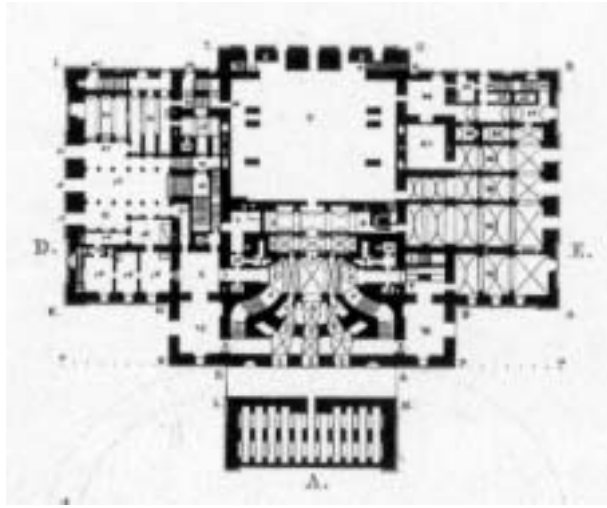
Erdgeschossgrundriss des Schauspielhauses mit der Eingangssituation hinter der Freitreppe. Schinkel 1821
